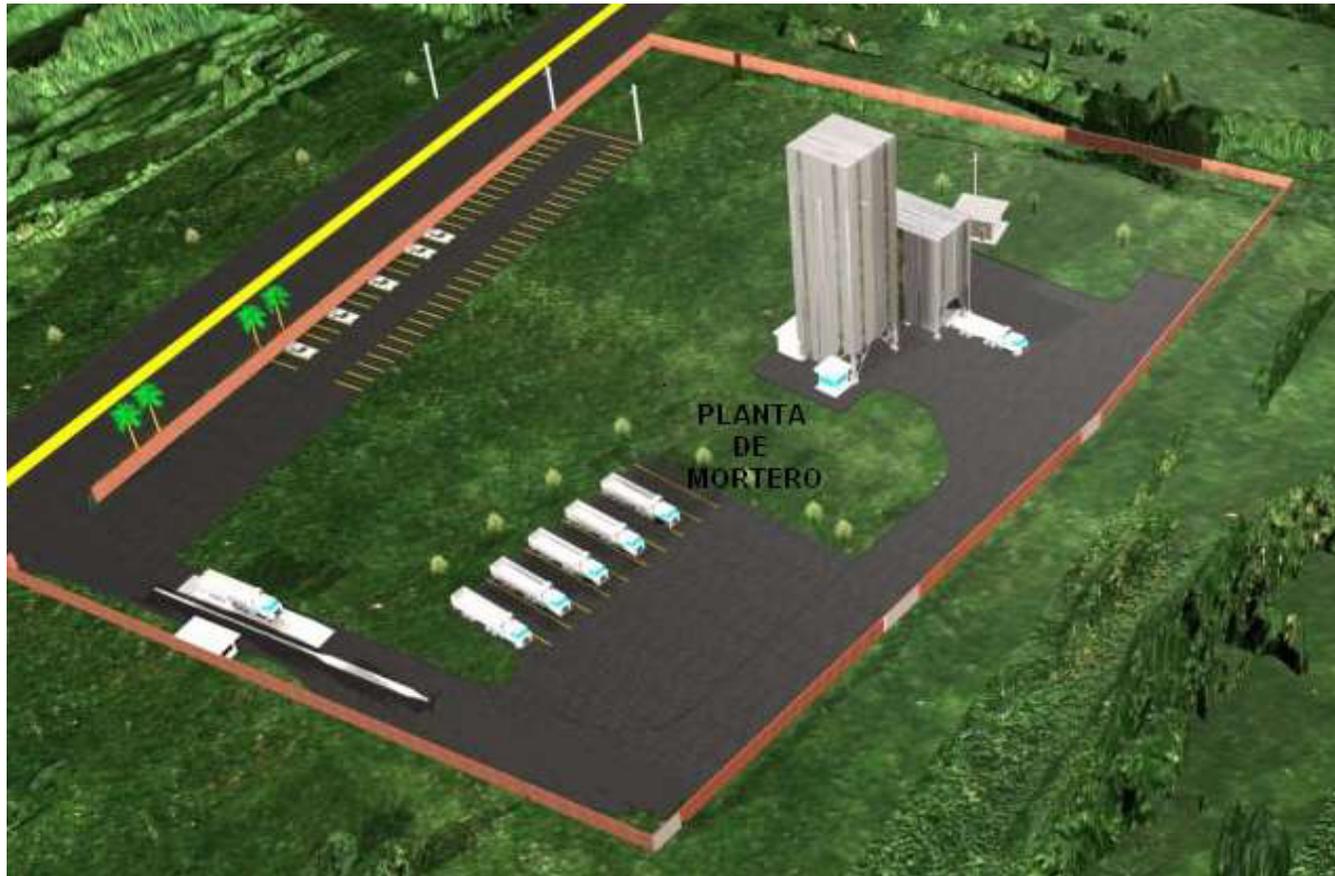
AREA PARA PLANTA DE MORTERO SECO (13)
